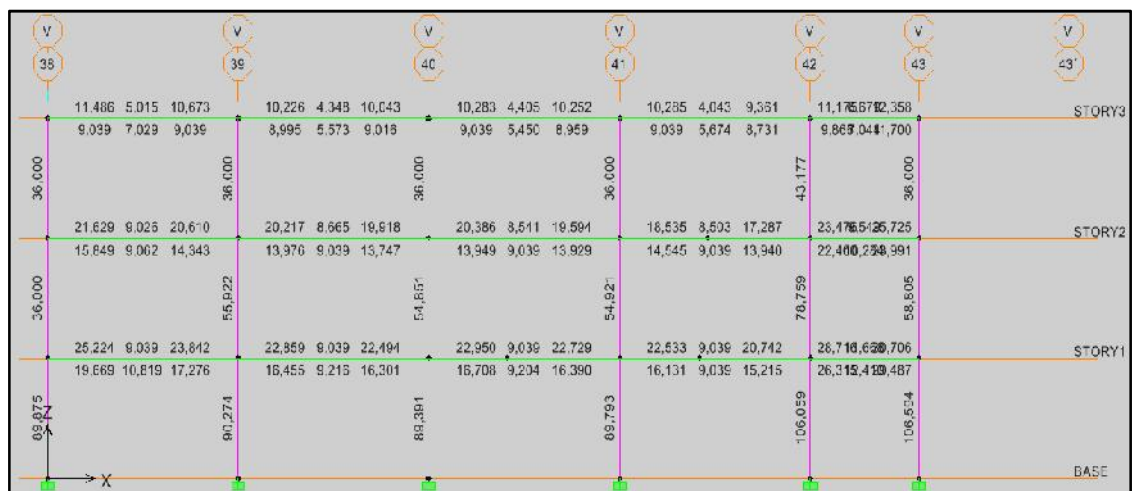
Acero en vigas pórtico V, Consulta Externa I
